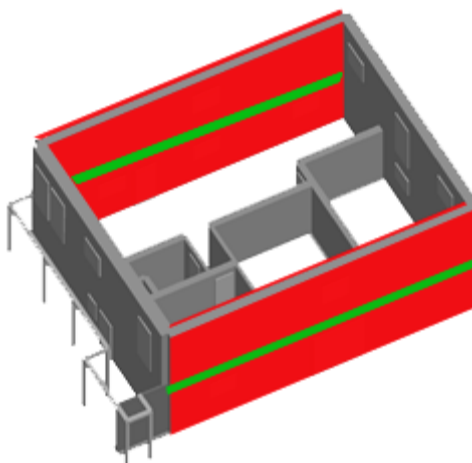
Esquema de introdução de tirantes ao nível do pavimento do piso 1 e execução de reboco armado nas duas faces das fachadas laterais
